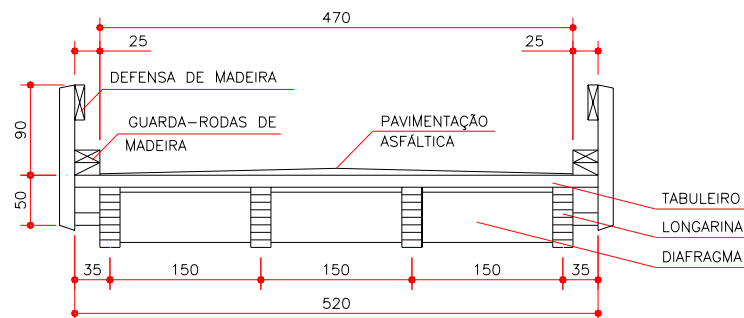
Seção transversal da ponte em vigas de MLC com uma faixa de tráfego
